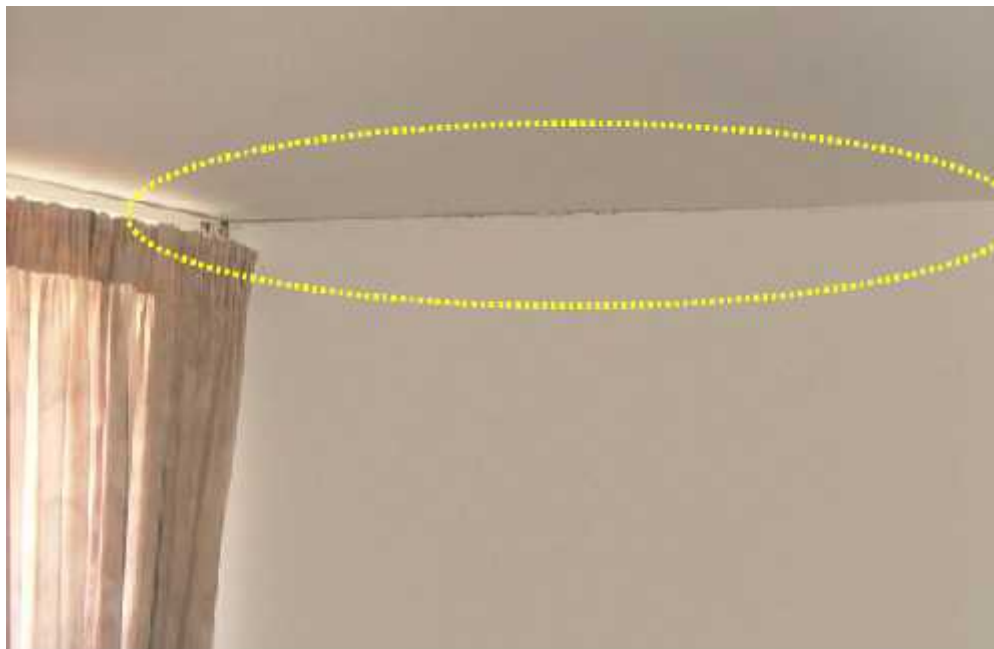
Fissuração horizontal ao longo da intersecção parede-laje.
